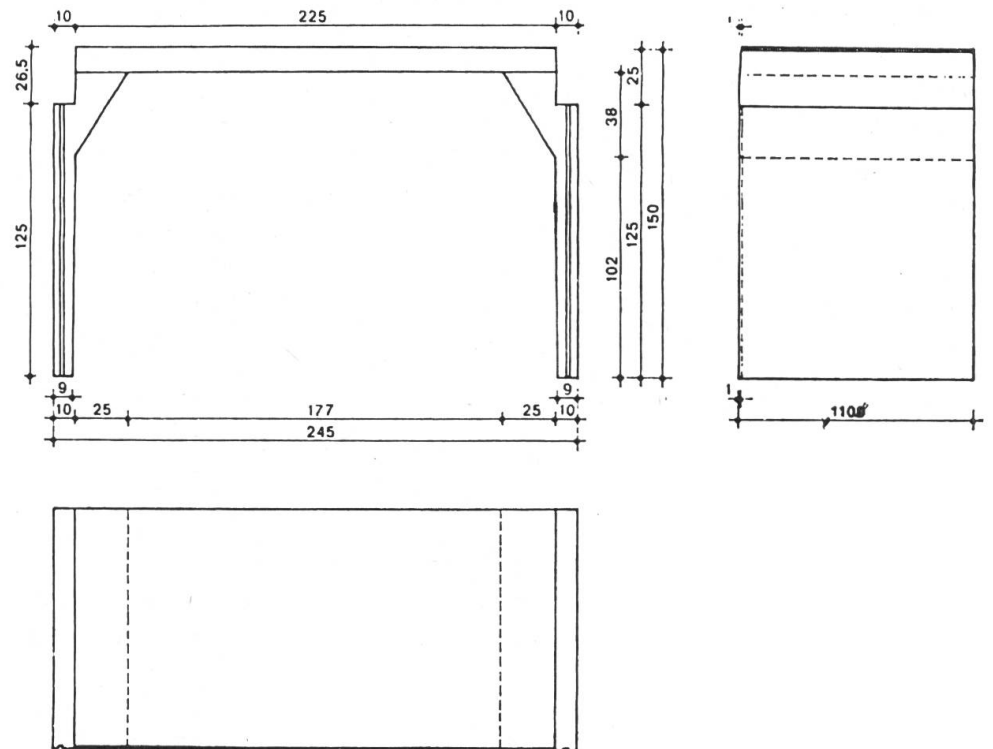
Vorgefertigte Tunnelemente aus Beton.
